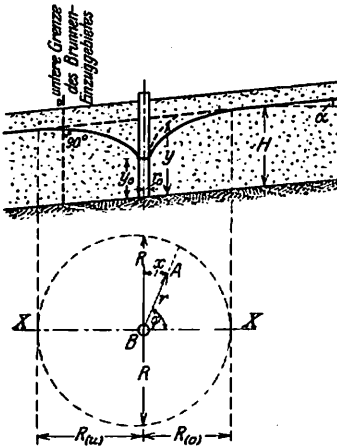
Einzelbrunnen in strömendem Grundwasser.
